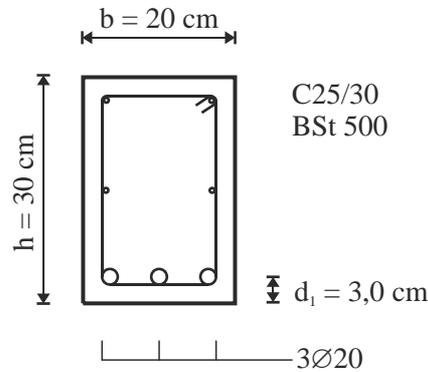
Beispiel „Querschnitt eines Stahlbetonbalkens“ – Geometrie und Baustoffe
